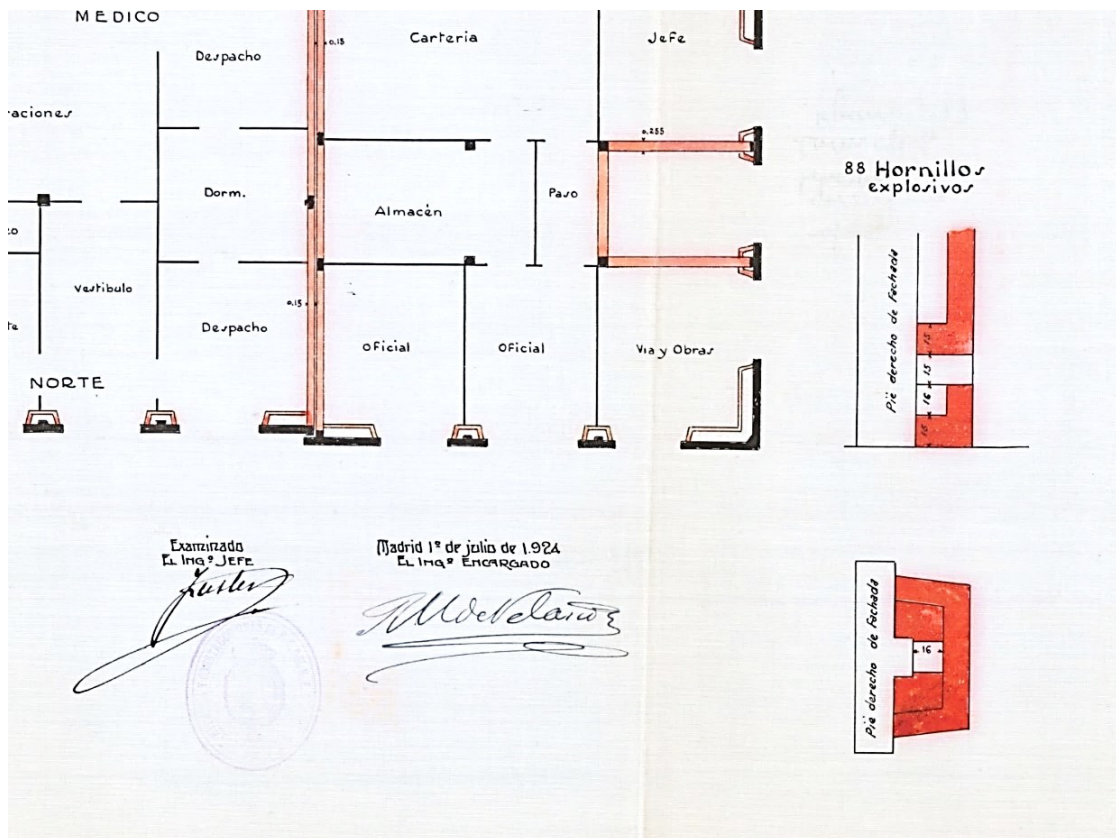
Detalle del plano de distribución de la planta baja del Edificio de Servicio, realizado por Martínez de Velasco, donde aparece el hueco u «hornillo» para la ubicación del explosivo entre el trasdosado de ladrillo tabiquero y el hormigón de la base de cada pilar. AGA, Caja 24/11308.
